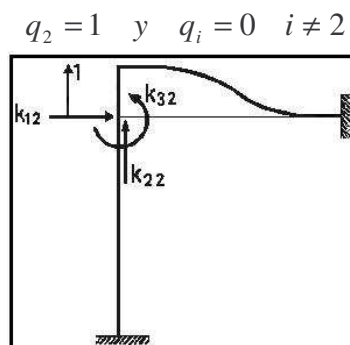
Elementos de la segunda columna de \mathbf{K} . Sistema B.
